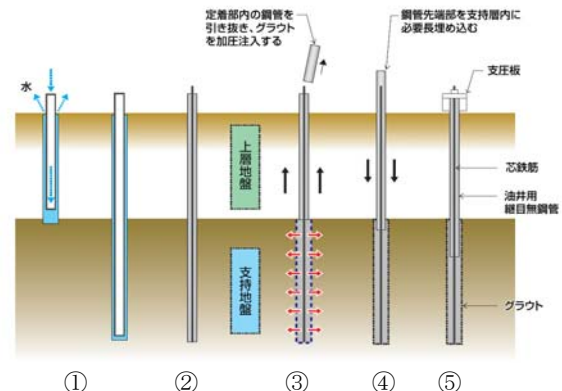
高耐力マイクロパイル工法の標準的な施工手順
